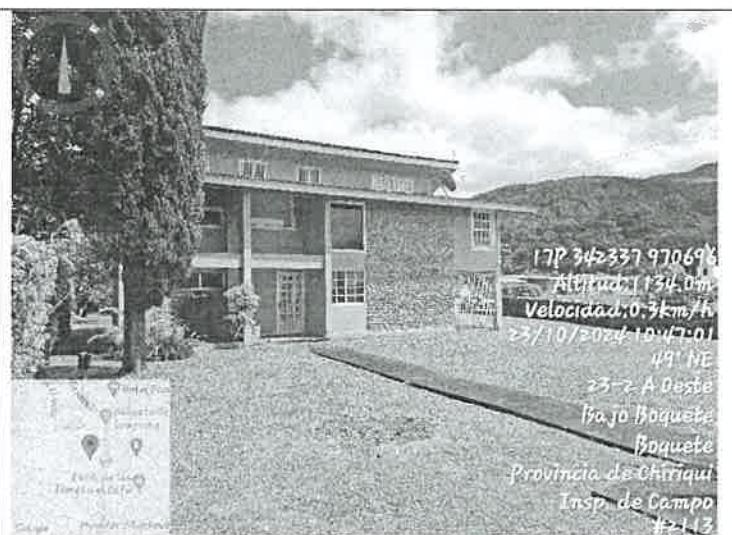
Vista parcial del terreno, vegetación y casa existente.
